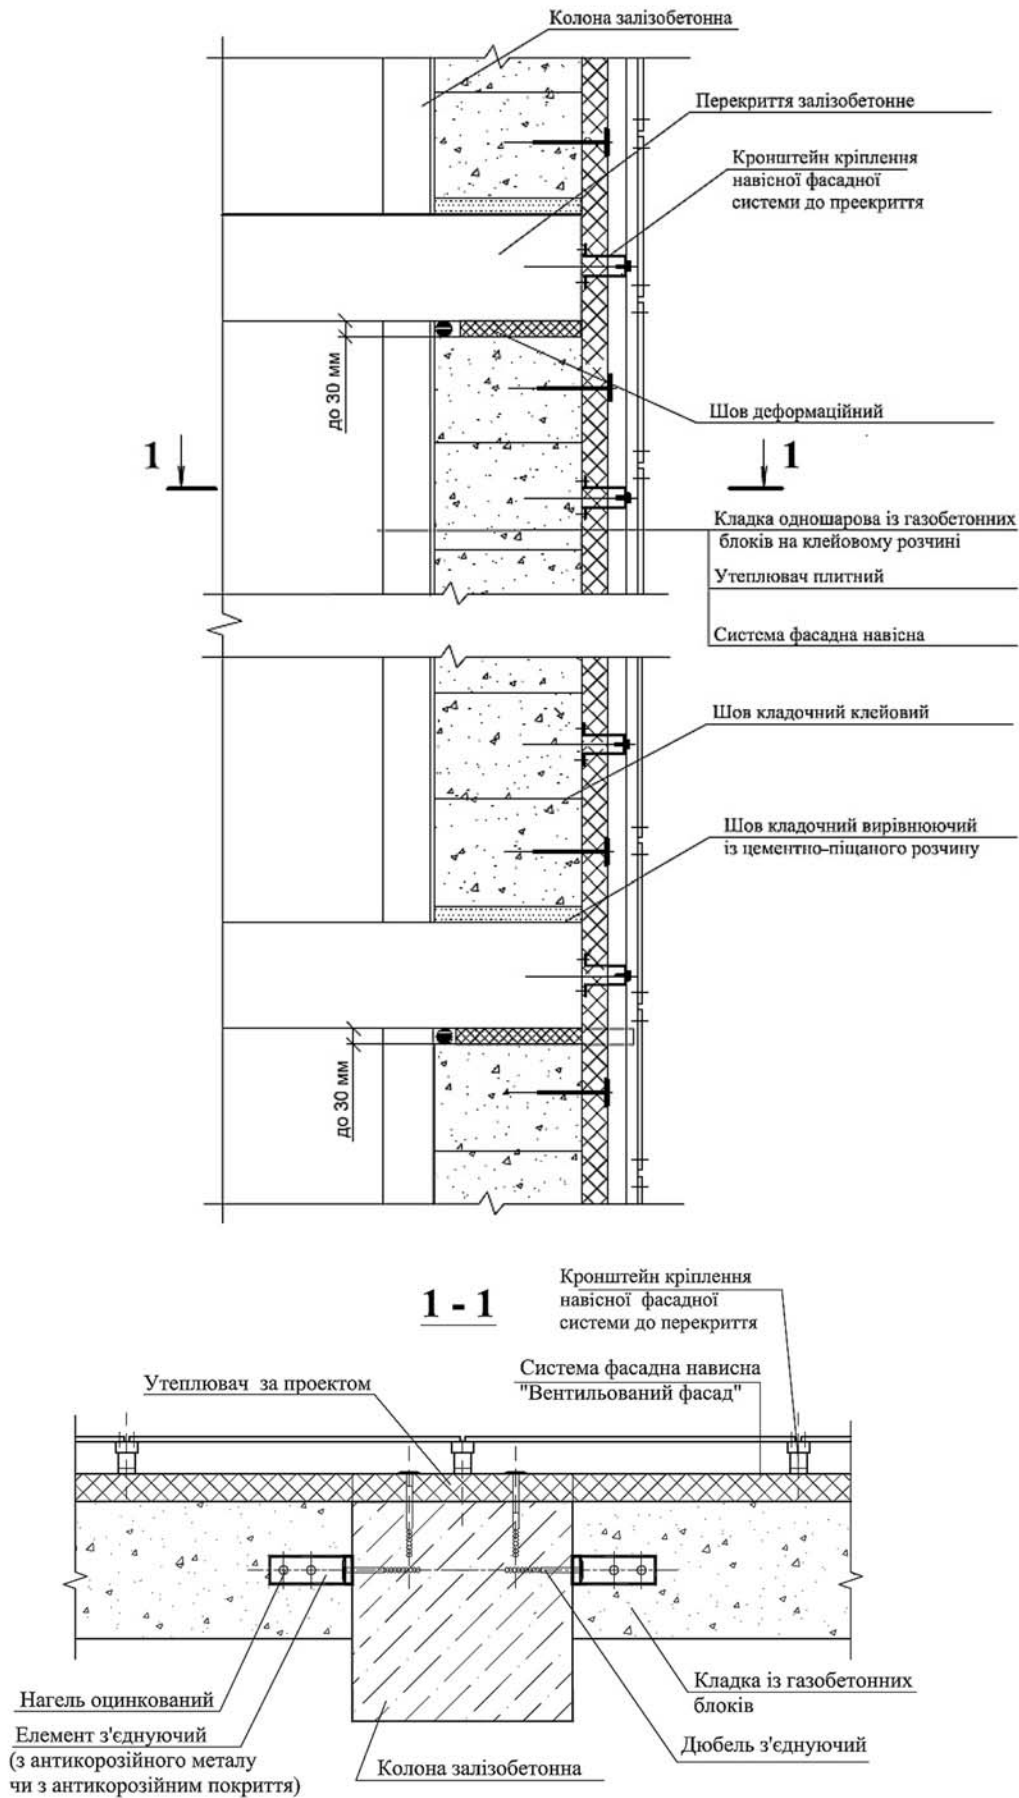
Стіна зовнішня багатошарова із газобетонних блоків із плитним утеплювачем та навісною фасадною системою
